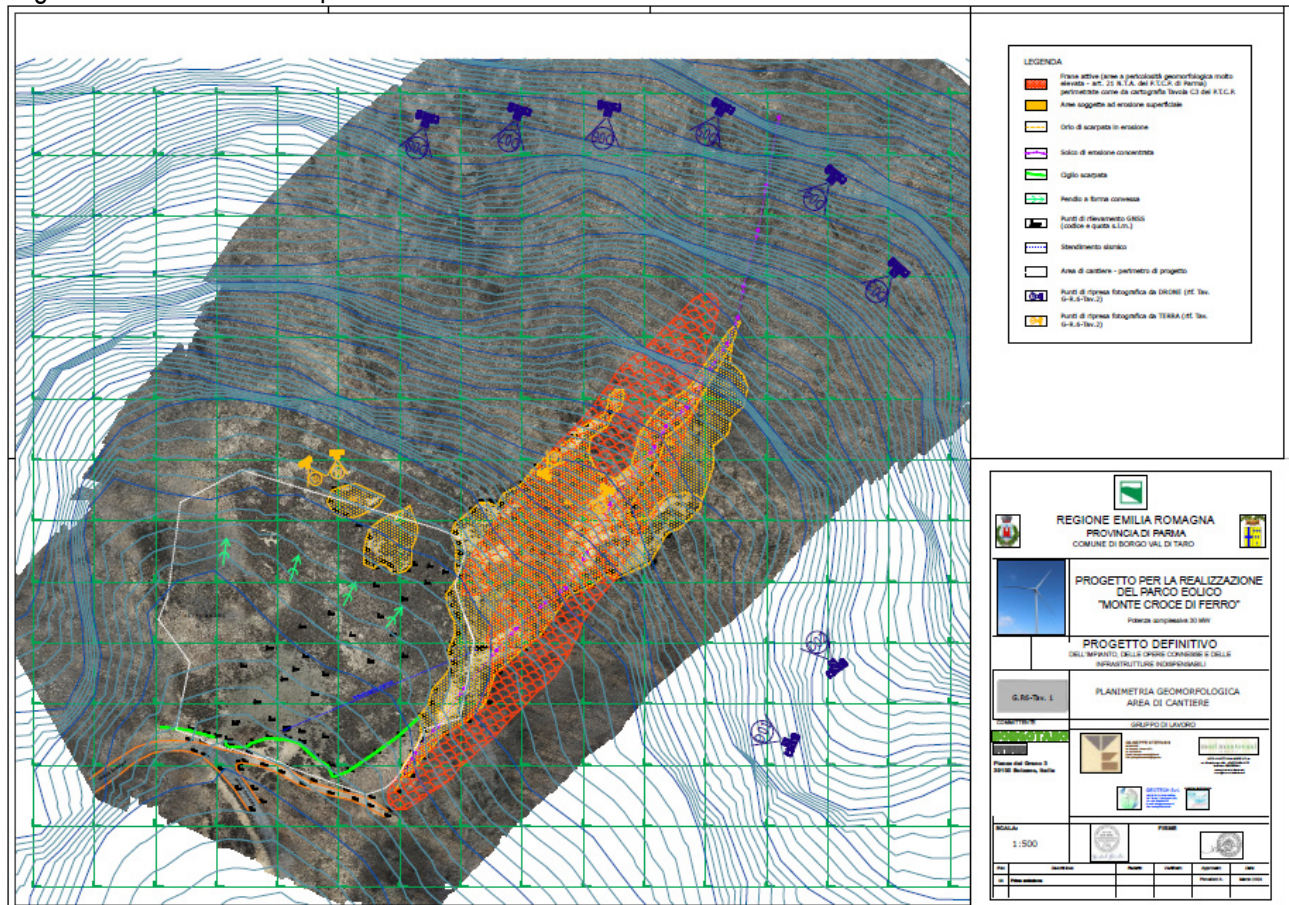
Stralcio da G-R.6 Tav. 1 Planimetria geomorfologica area di cantiere
